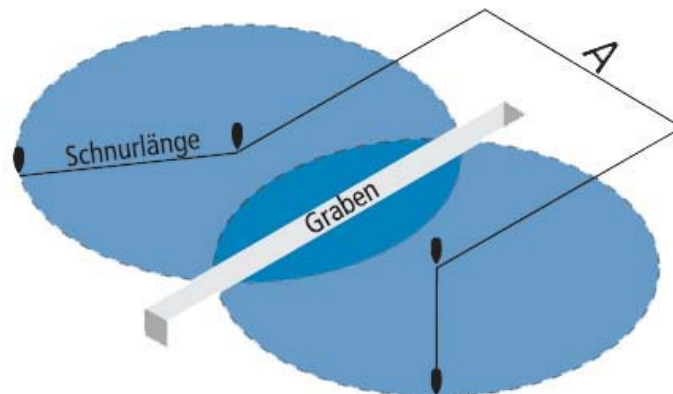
Grundrissmarkierung Achtformpool
